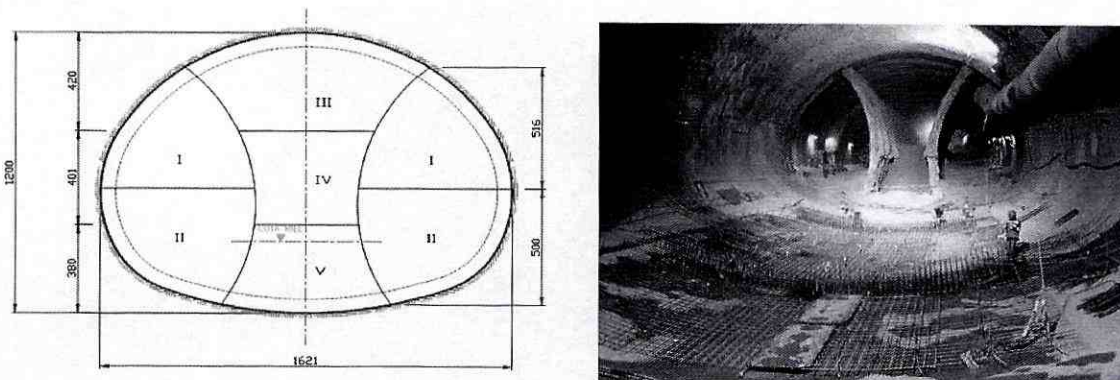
División de la sección completa del túnel excavada en 7 subsecciones de menor área.
